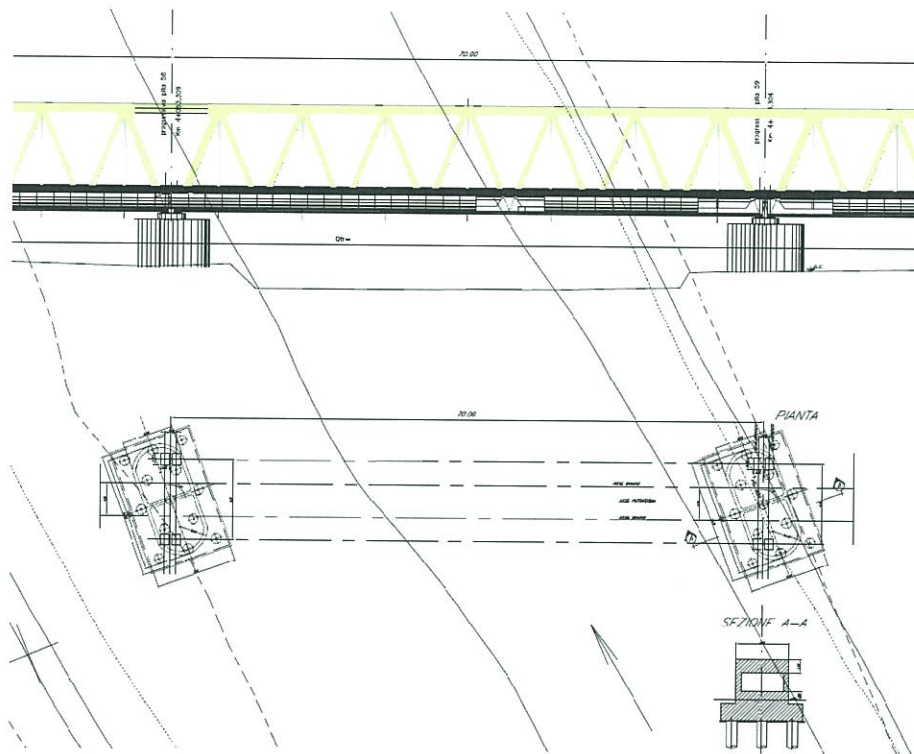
Campate da 70 m su fiume Biferno: pianta fondazioni
